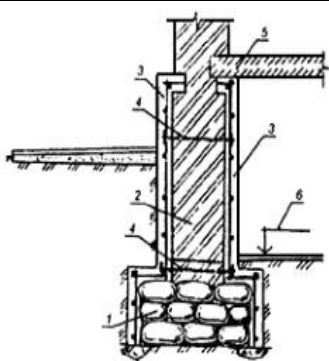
Устройство железобетонной обоймы для ленточного бутового или кирпичного фундамента 1 — усиливаемый бутовый фундамент; 2 — усиливаемая кирпичная стена; 3 — железобетонная обойма; 4 — анкеры; 5 — надподвальное перекрытие; 6 — отметка пола подвала; 7 — зона обжатого грунта основания.
